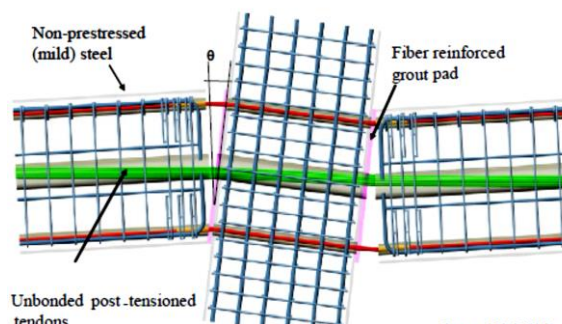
Disposición cable postesado y barras de acero dúctil: Unión viga-columna (Fuente: Pampanin, 2005)
